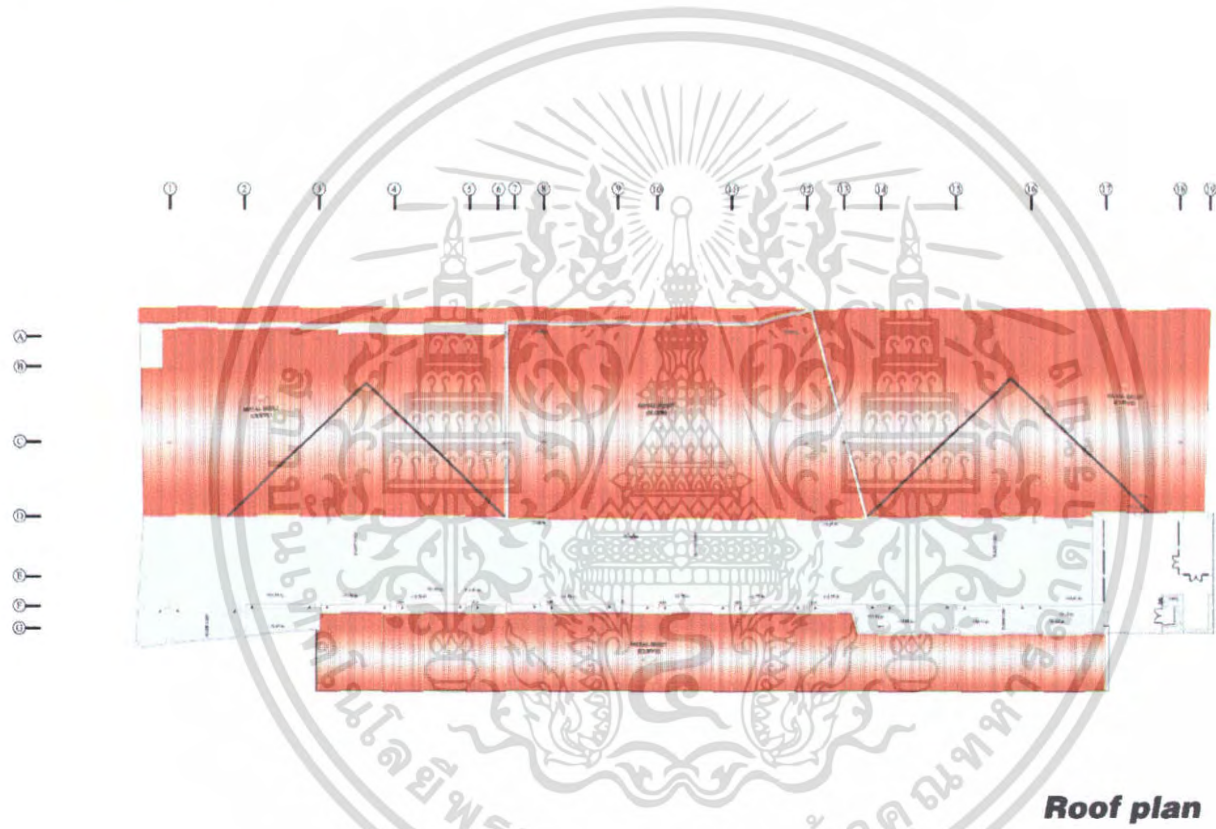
แสดงผังบริเวณ (lay out)
